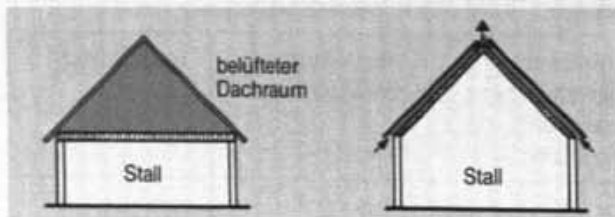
Kaltdach; links: mit ebener Decke, rechts: mit schräger Decke.
